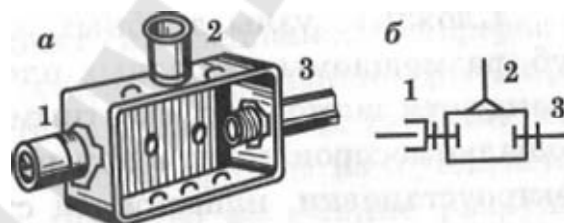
Ответвительная коробка с присоединением труб к корпусу: *a* – внешний вид; *б* – условное обозначение; 1 – патрубок с заземляющими цапающими гайками; 2 – муфта, приваренная к коробке; 3 – ввод трубы с полусгоном
